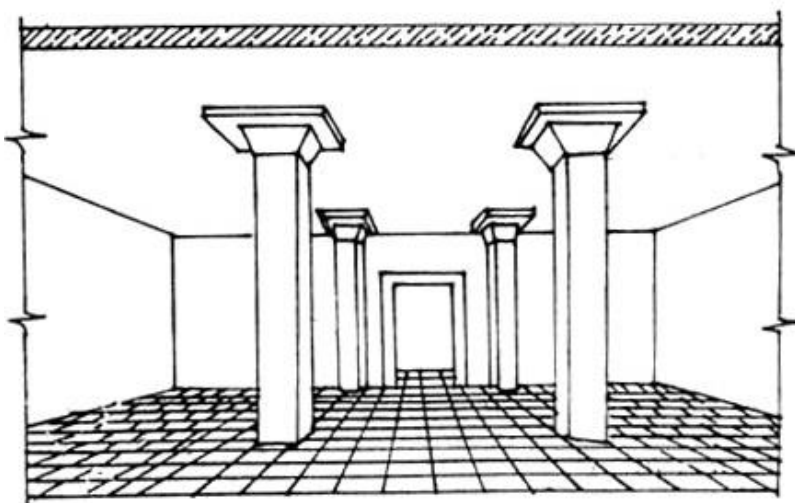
Общий вид железобетонного безбалочного монолитного перекрытия
